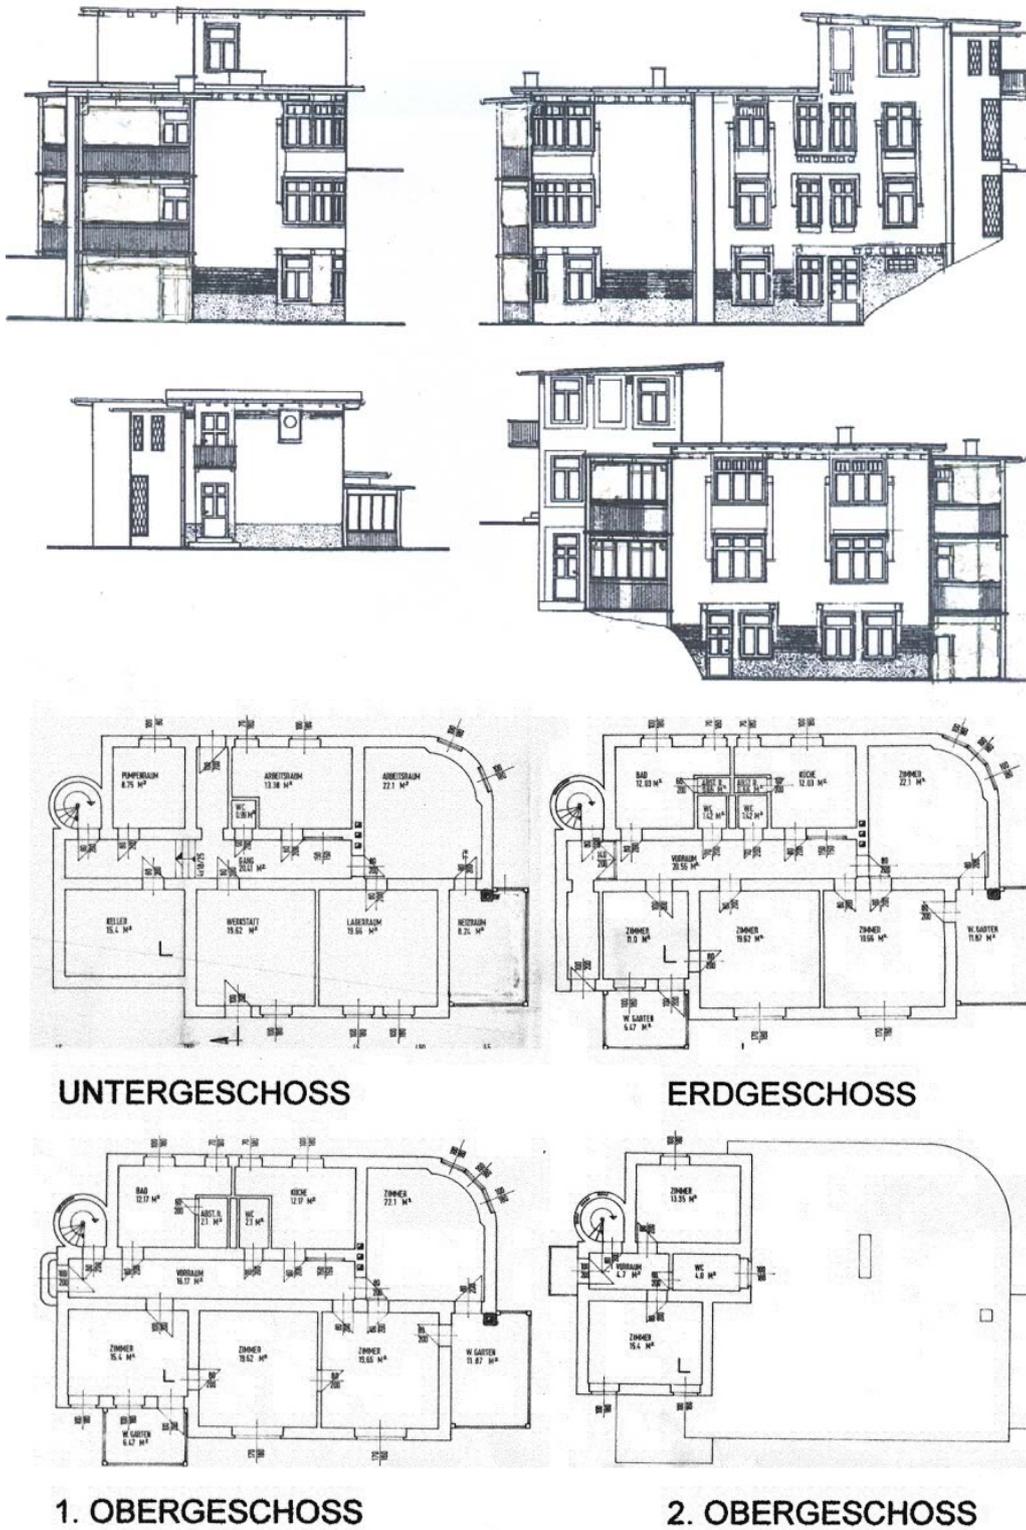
ANSICHTEN UND GRUNDRISSSE DER VILLA BETONIA
